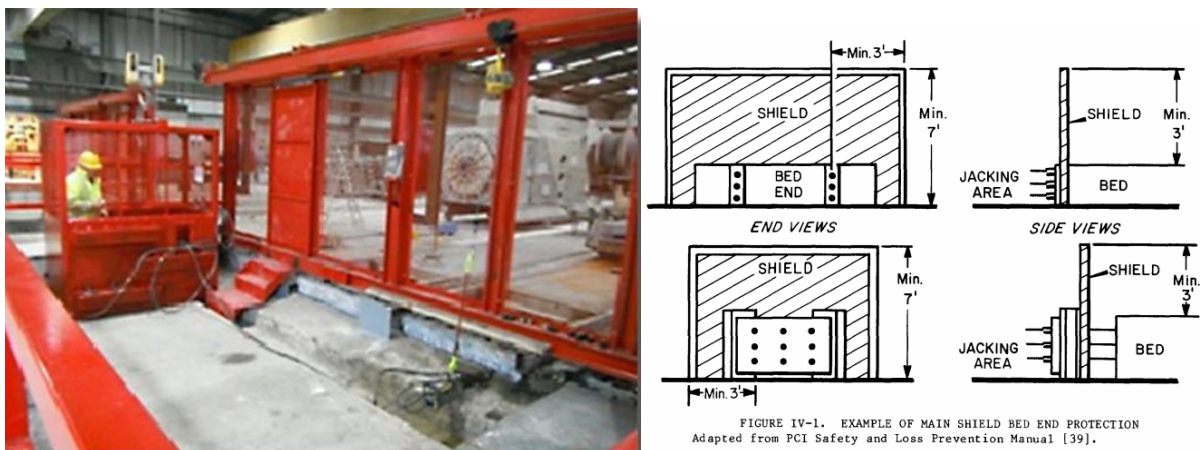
a Escudos de protección contra ruptura de torón. Fuente: Manual for Fabrication of Precast Prestressed Concrete Products” elaborado por el Departamento del Transporte de Illinois, EUA
